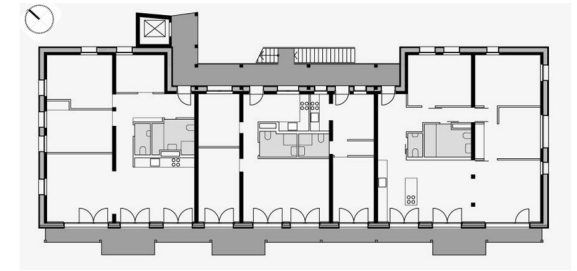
Pianta tipo della residenza KleeHaus; Fonte: www.giesarchitekten.de
